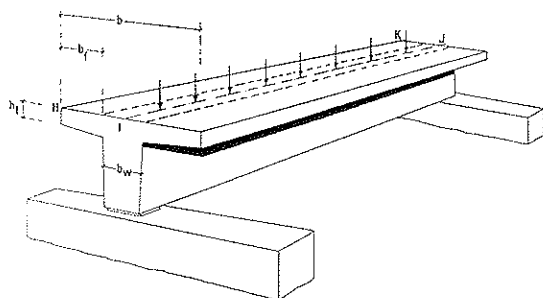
Viga de hormigón, de sección en T, bajo la acción de una carga uniformemente repartida, aplicada en la anchura  $b_w$  del nervio.
